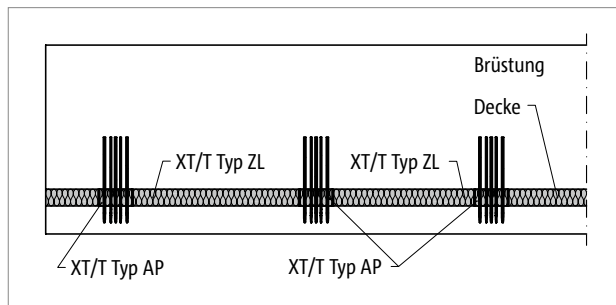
Schöck Isokorb® XT/T Typ AP vertikale Anordnung: Ansicht Brüstung aufgesetzt
